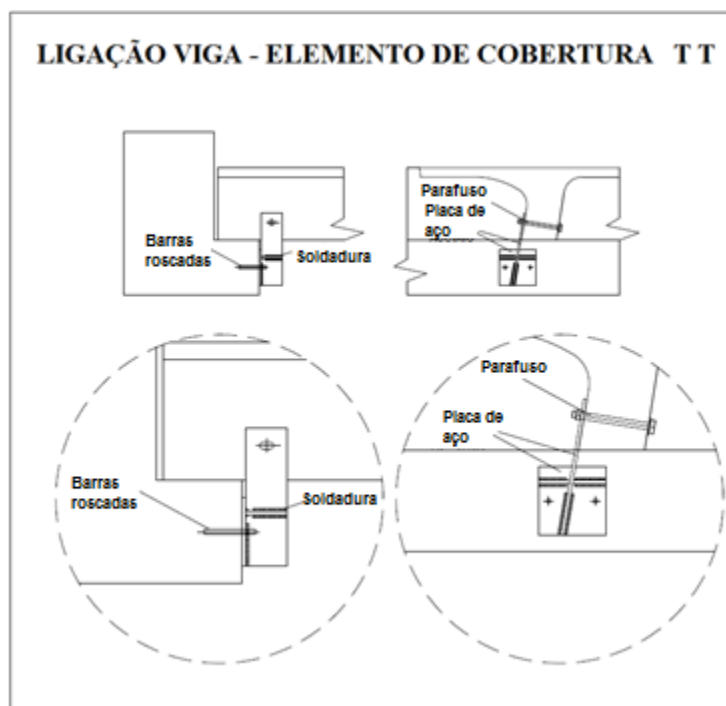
Detalhe da intervenção da ligação entre elemento de cobertura TT e viga no presente caso de estudo
